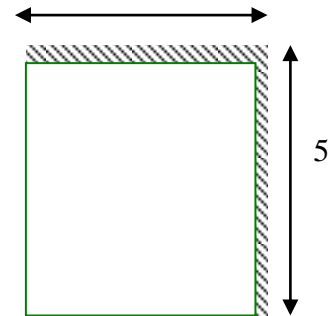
Dimensions du panneau de dalle le plus sollicité
